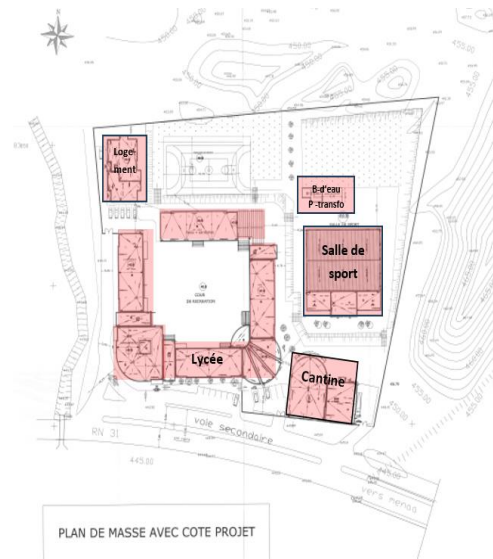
Plan de masse Avec cote projet Echelle :1/250
